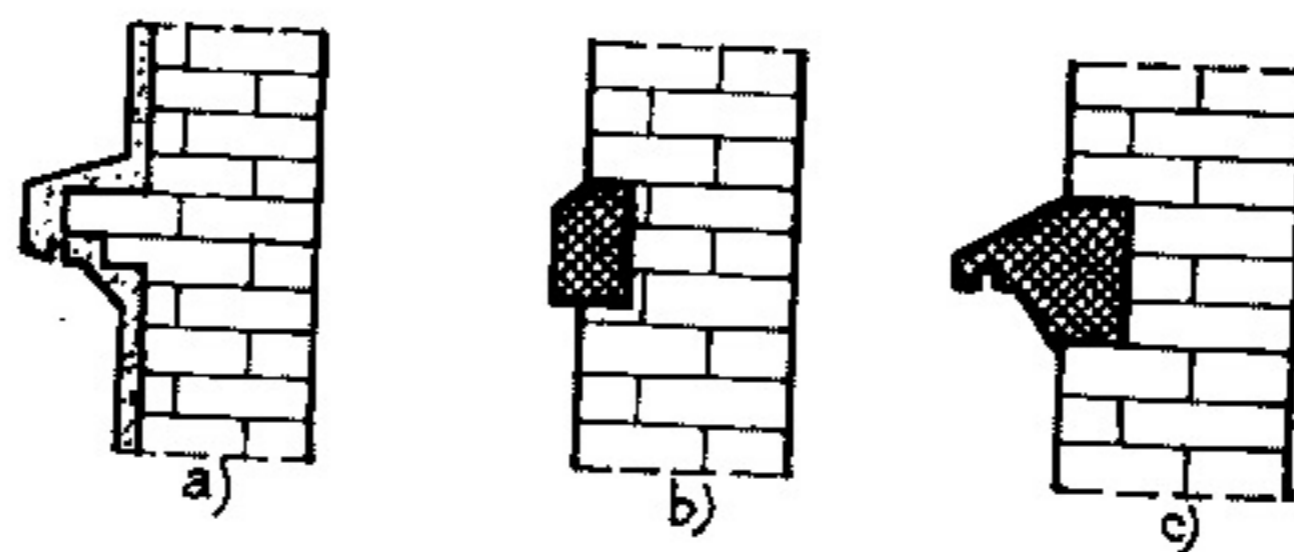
Cornișe din: a - zidărie tencuită; b - piatră naturală; c - beton
